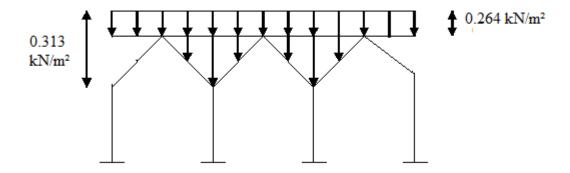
Charges de la neige sur la toiture avec accumulation.
